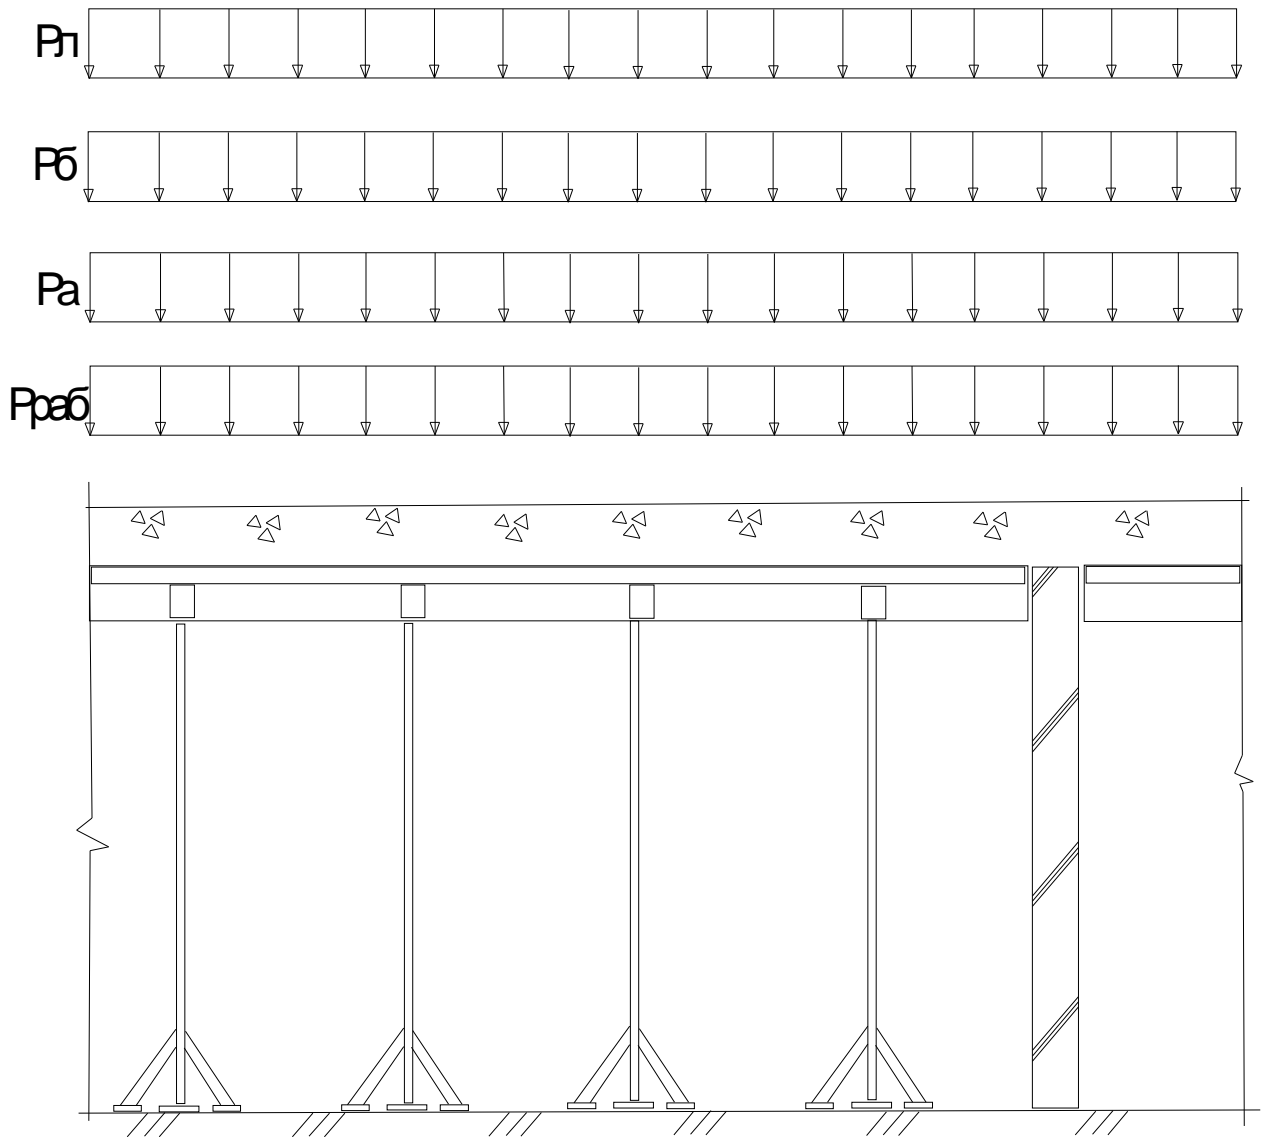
Расчетно-конструктивная схема опалубки перекрытия
